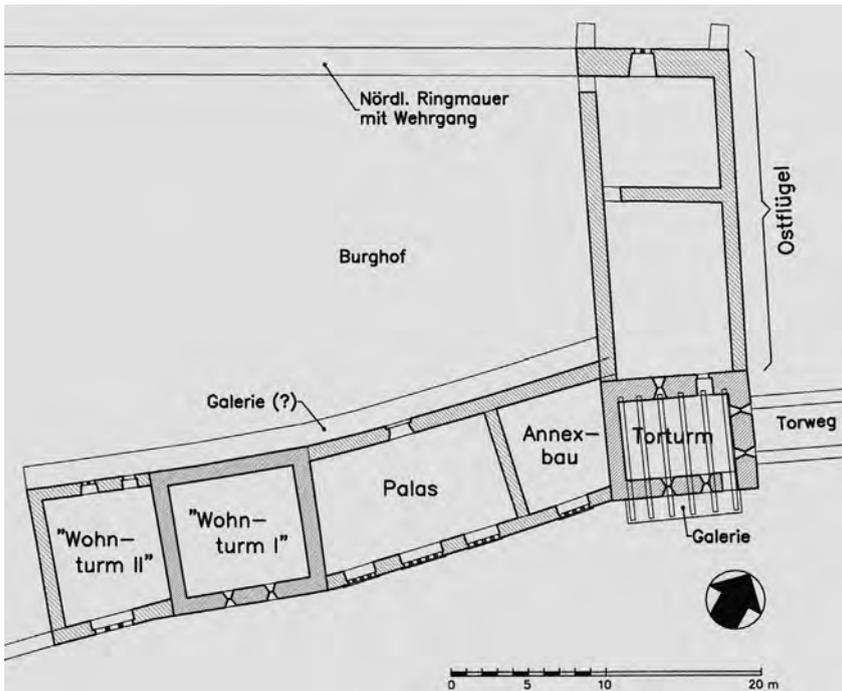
Grundriss östlicher Südflügel und Querhaus (1. Obergeschoss) mit Darstellung des romanischen Baubestandes. Plangrundlage: Bestandsaufnahme W. Pfefferkorn 1994 ff.
